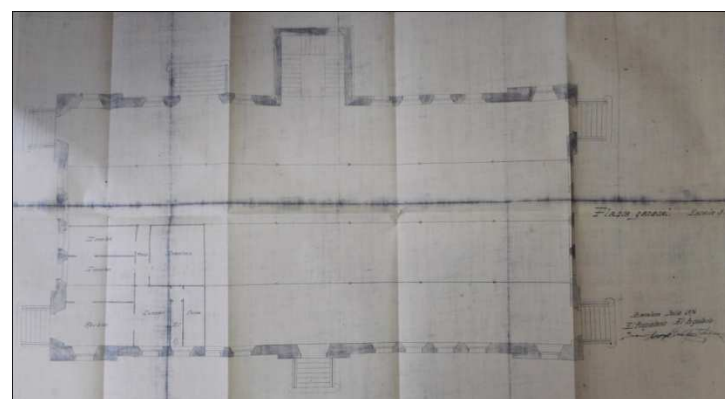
Plànol original de la planta general de la fàbrica Torra.
